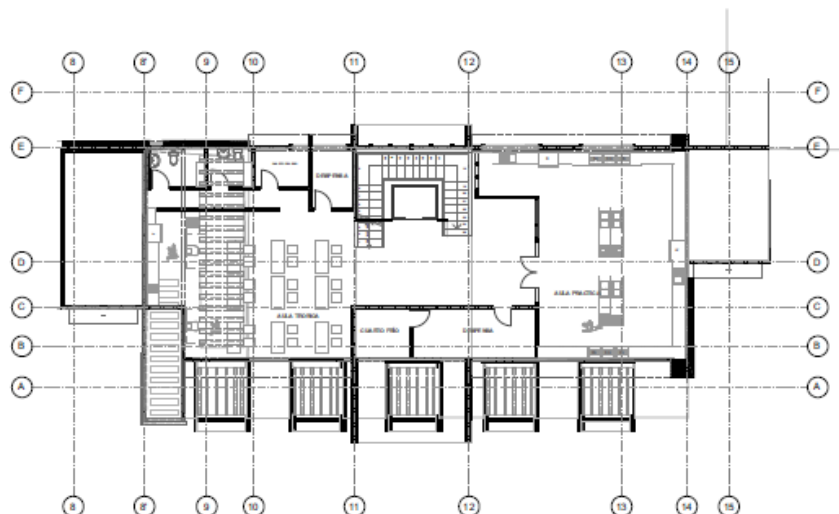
Planta arquitectónica tercer piso escuela taller Fuente: propia
